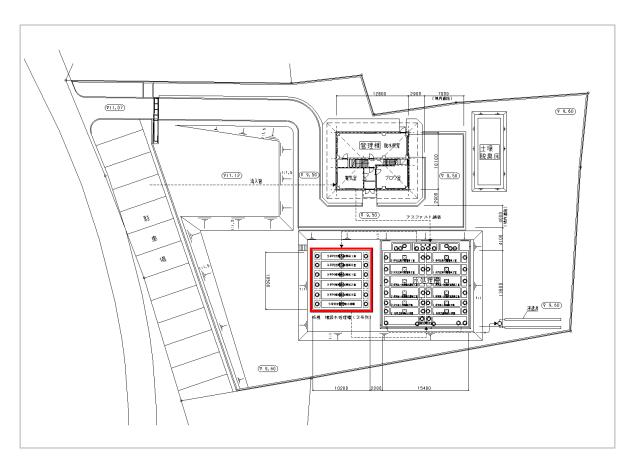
竹富浄化センター一般平面図 (赤枠が水処理施設3系)
